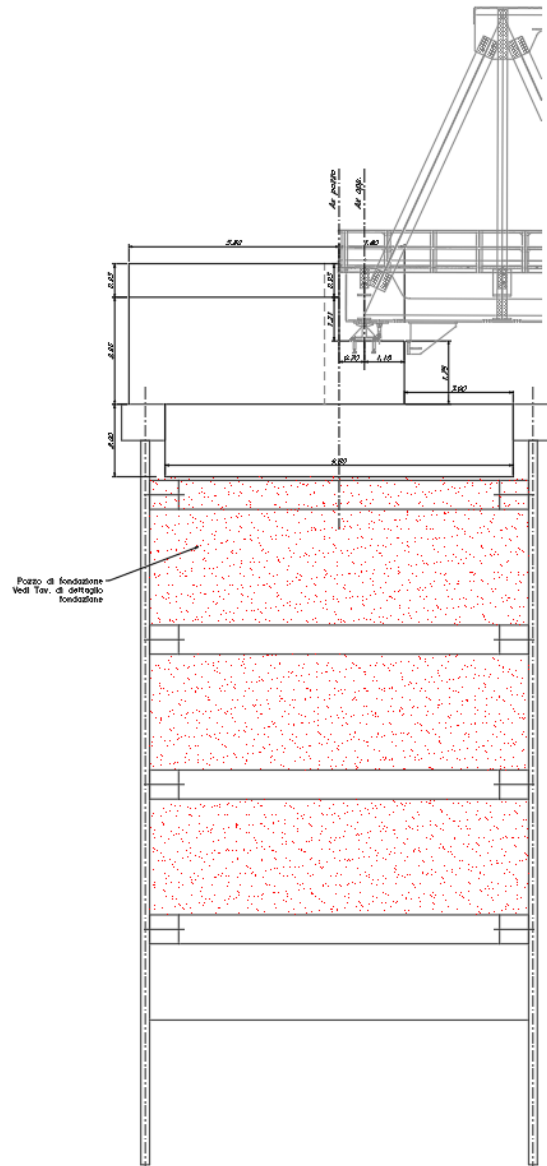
Prospetto Longitudinale Spalla A
